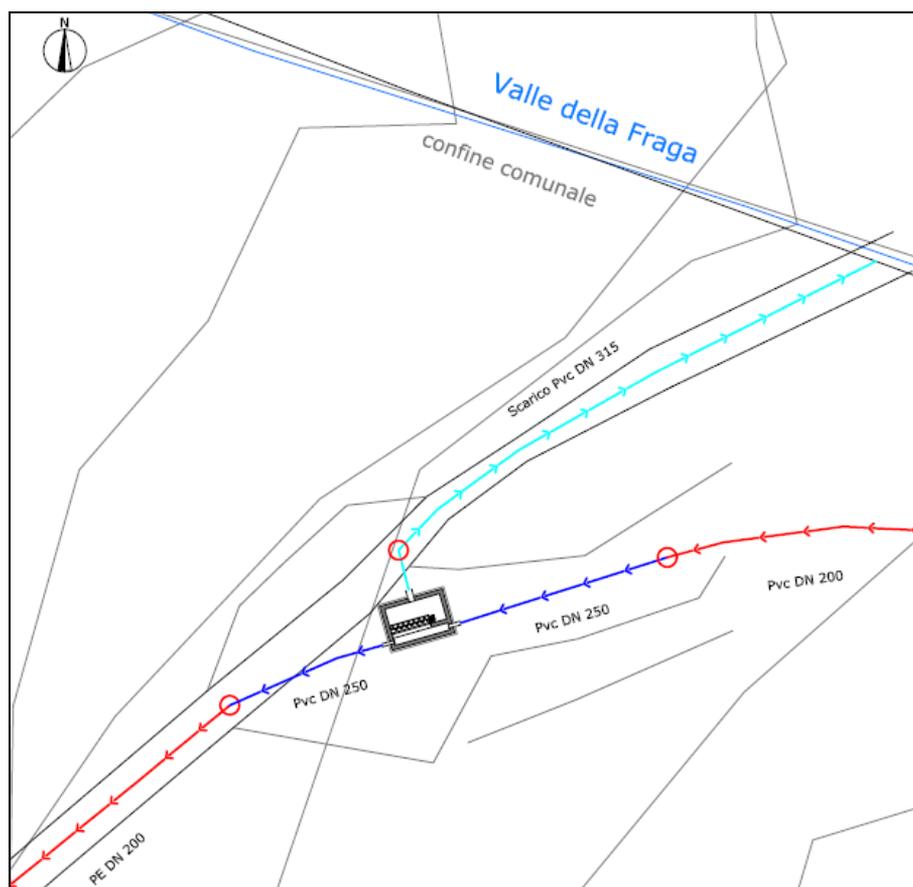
Estratto planimetrico non in scala dell'intervento di Loc. Spighetta (allo stato di progetto attuale)
